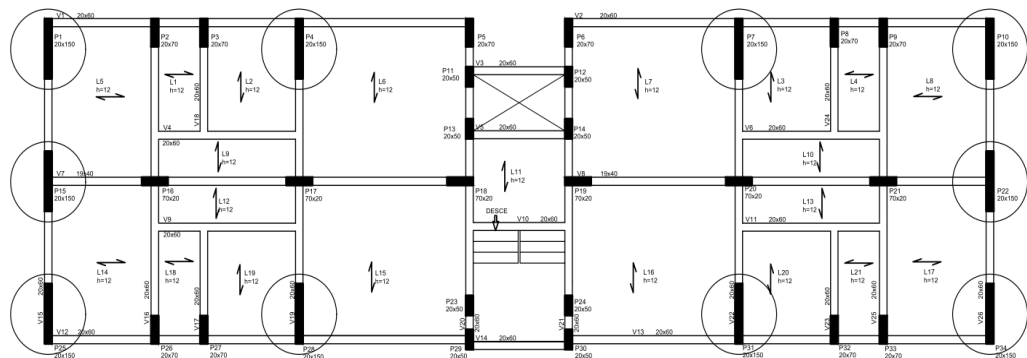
Planta tipo Caso 2.2 – 10 pilares-em-parede equidistantes e periféricos
